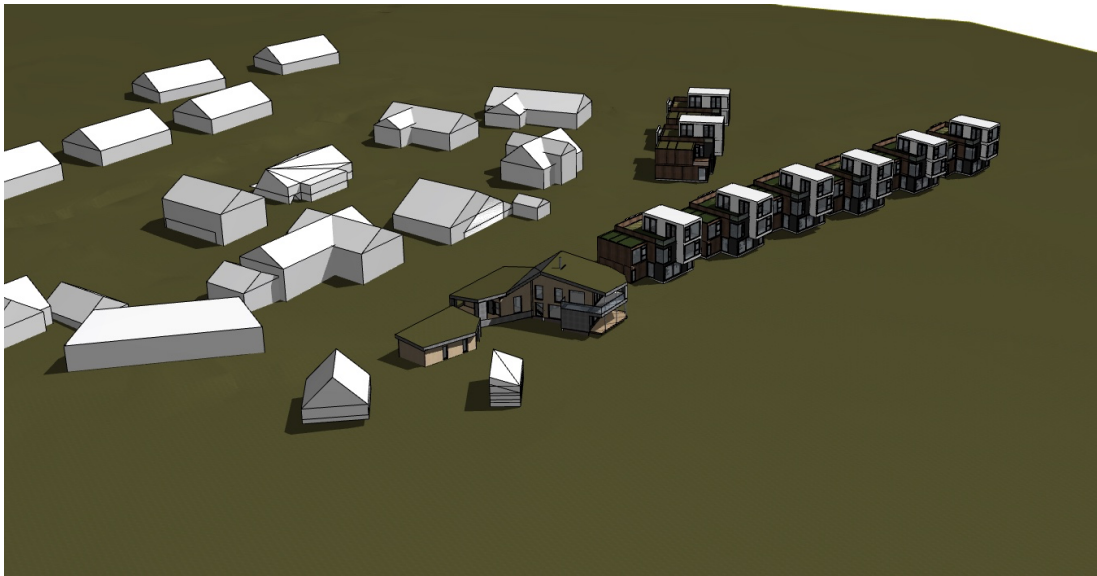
Illustrasjonsplan av fremtidig situasjon av planområdet
